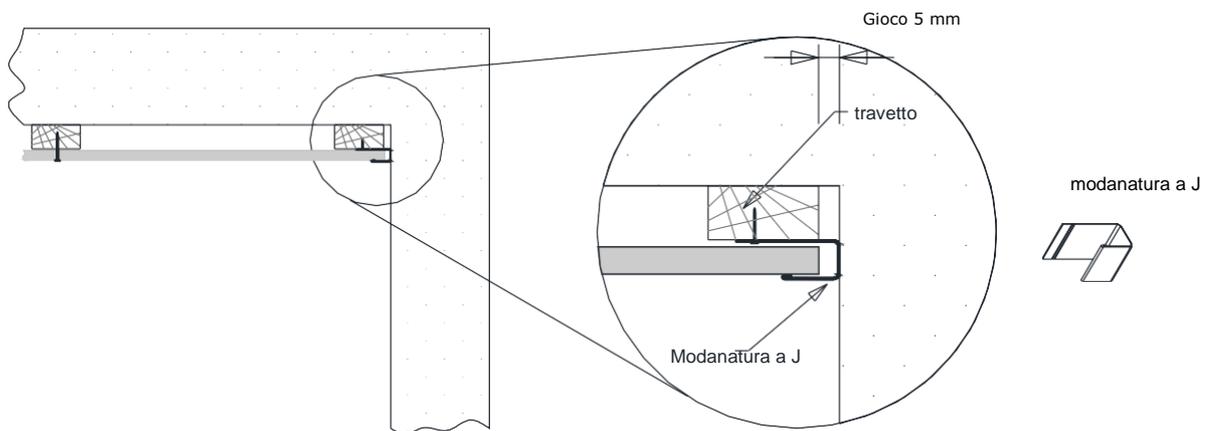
Profilo di arresto laterale contro muro (modanatura a J)
